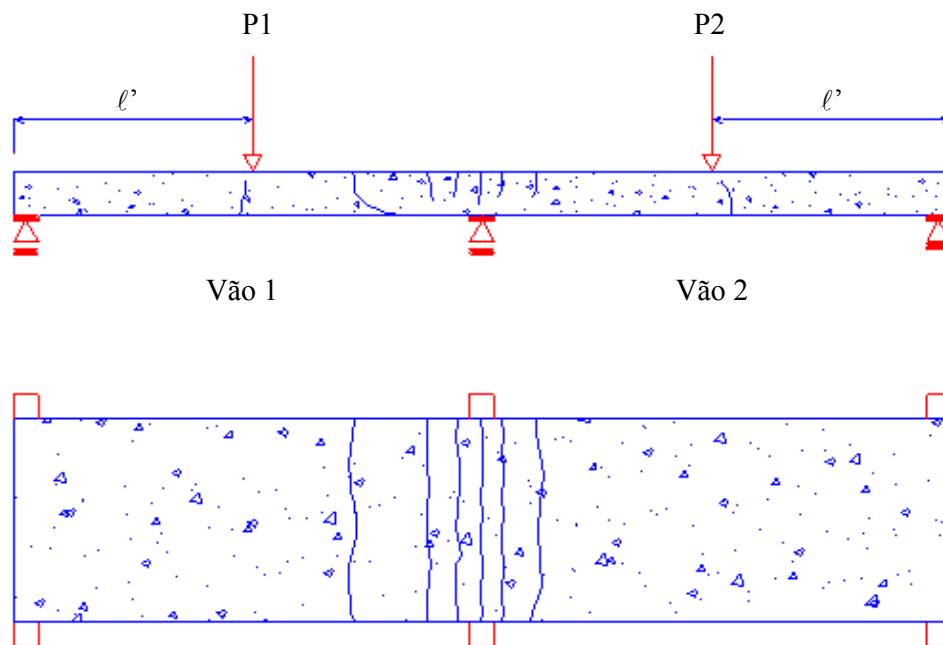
Perfil das fissuras no protótipo P1S2B
